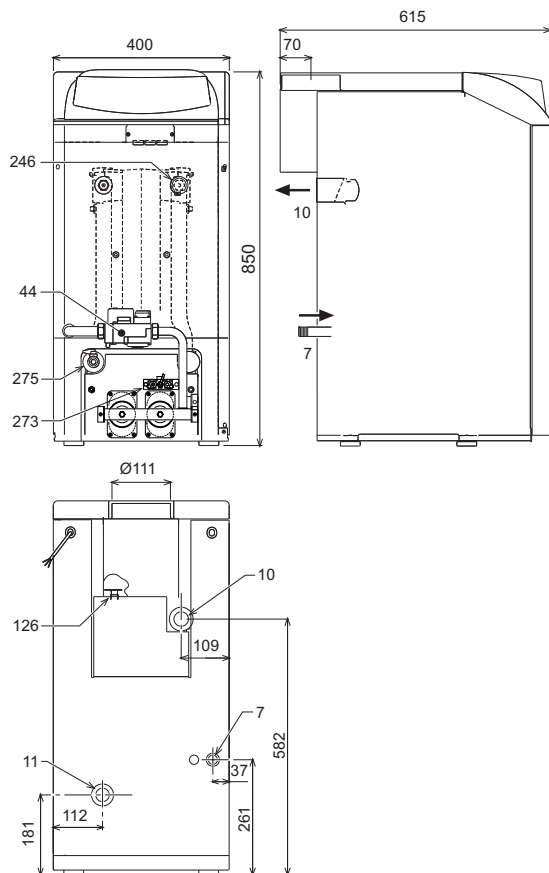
Dimensioni e attacchi mod. PEGASUS D 14 LN e PEGASUS D 20 LN
